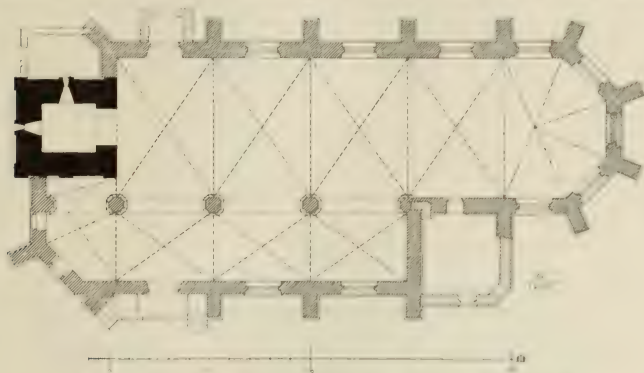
Königshoven. Grundriss der katholischen Pfarrkirche vor der Erweiterung
